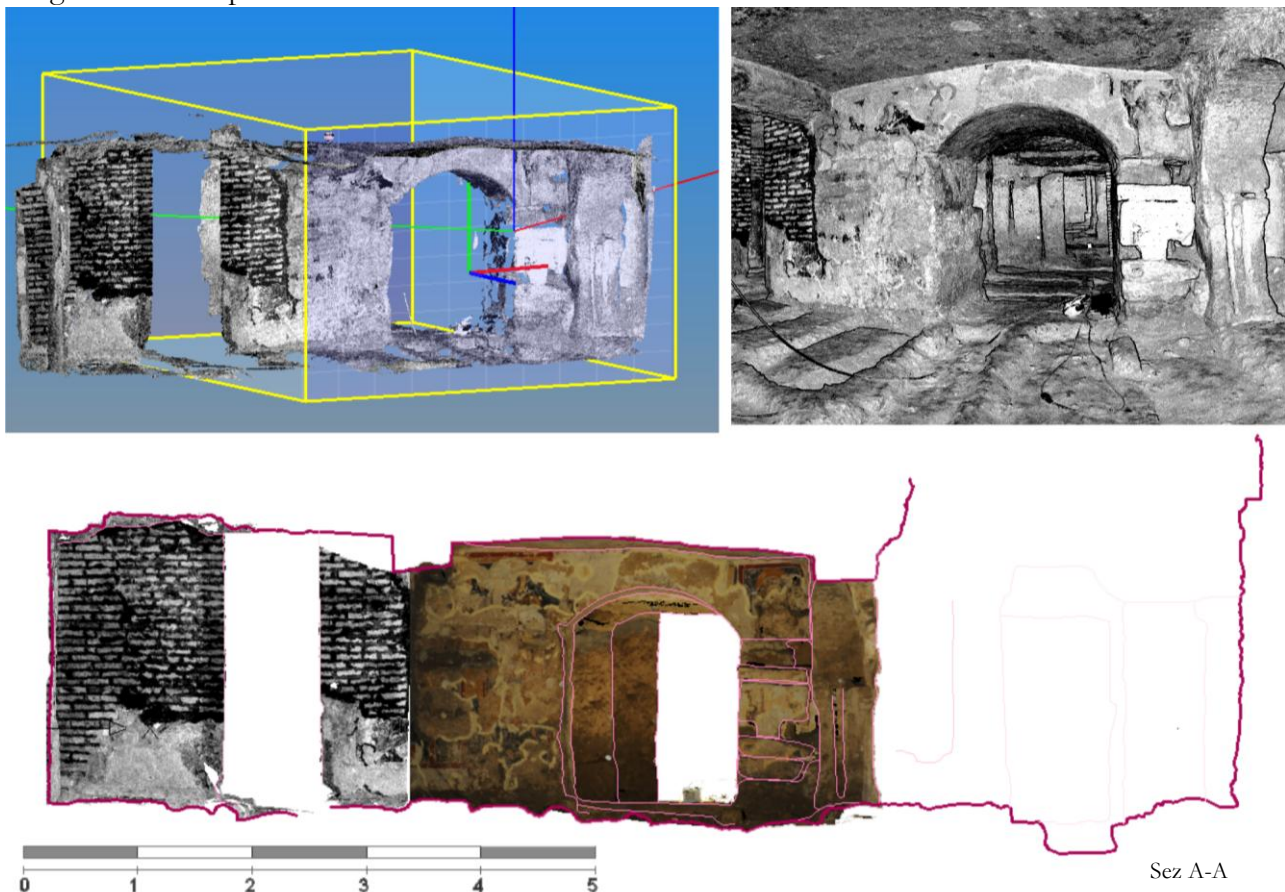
Individuazione del piano di sezione longitudinale dell'oratorio, vista del modello in modalità riflettanza, sezione A-A con texture RGB (affreschi palinsesti) e riflettanza (mattoni pressati).
